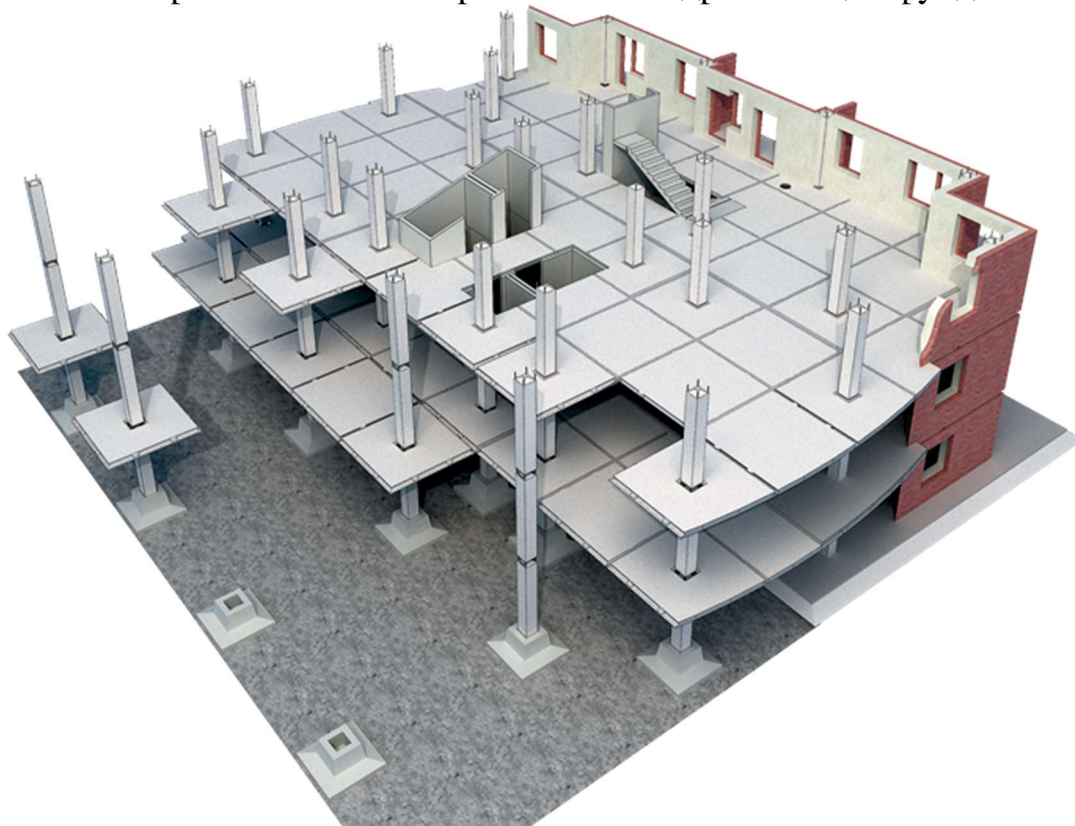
Схема монолитного железобетонного каркаса.
